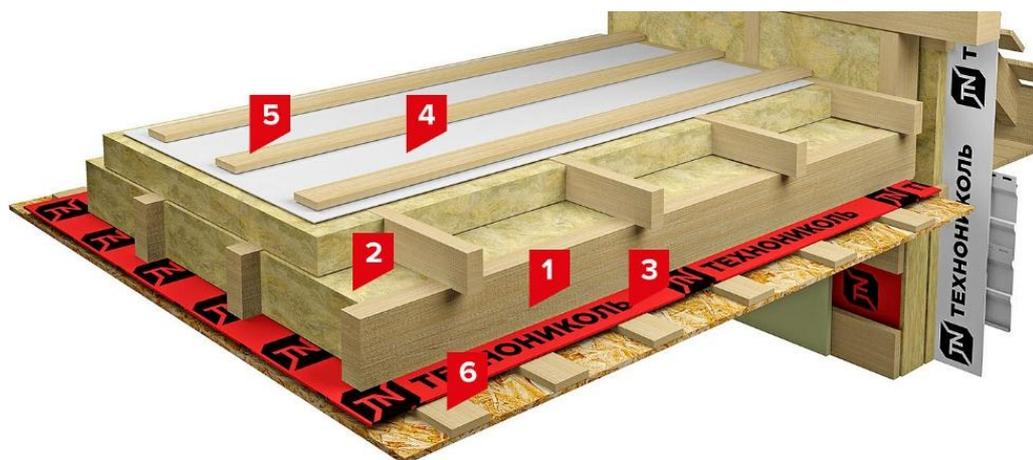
Конструктивное решение чердачного утепленного перекрытия по деревянным балкам:
